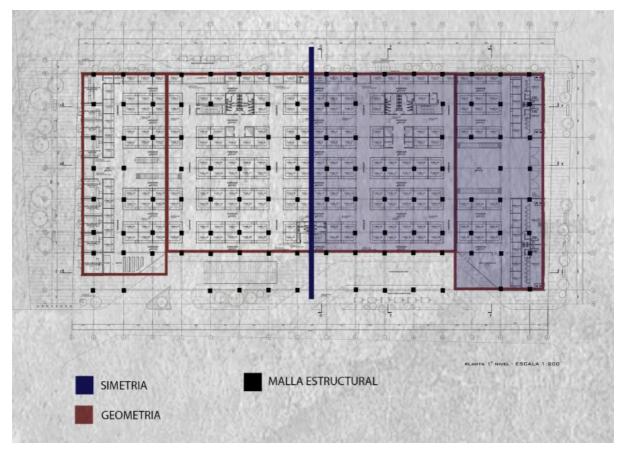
Simetría, estructura y geometría por /UNKU/FRUNA. Elaboración propia
